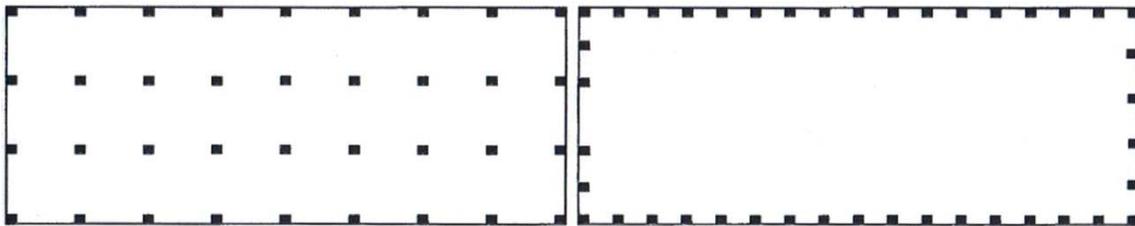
Disposición de los pilares en planta: a) Pilares distribuidos en toda la planta, b) Pilares concentrados en el perímetro. (Imagen tomada de [Gómez Hermoso et al. 2013, 95]).
